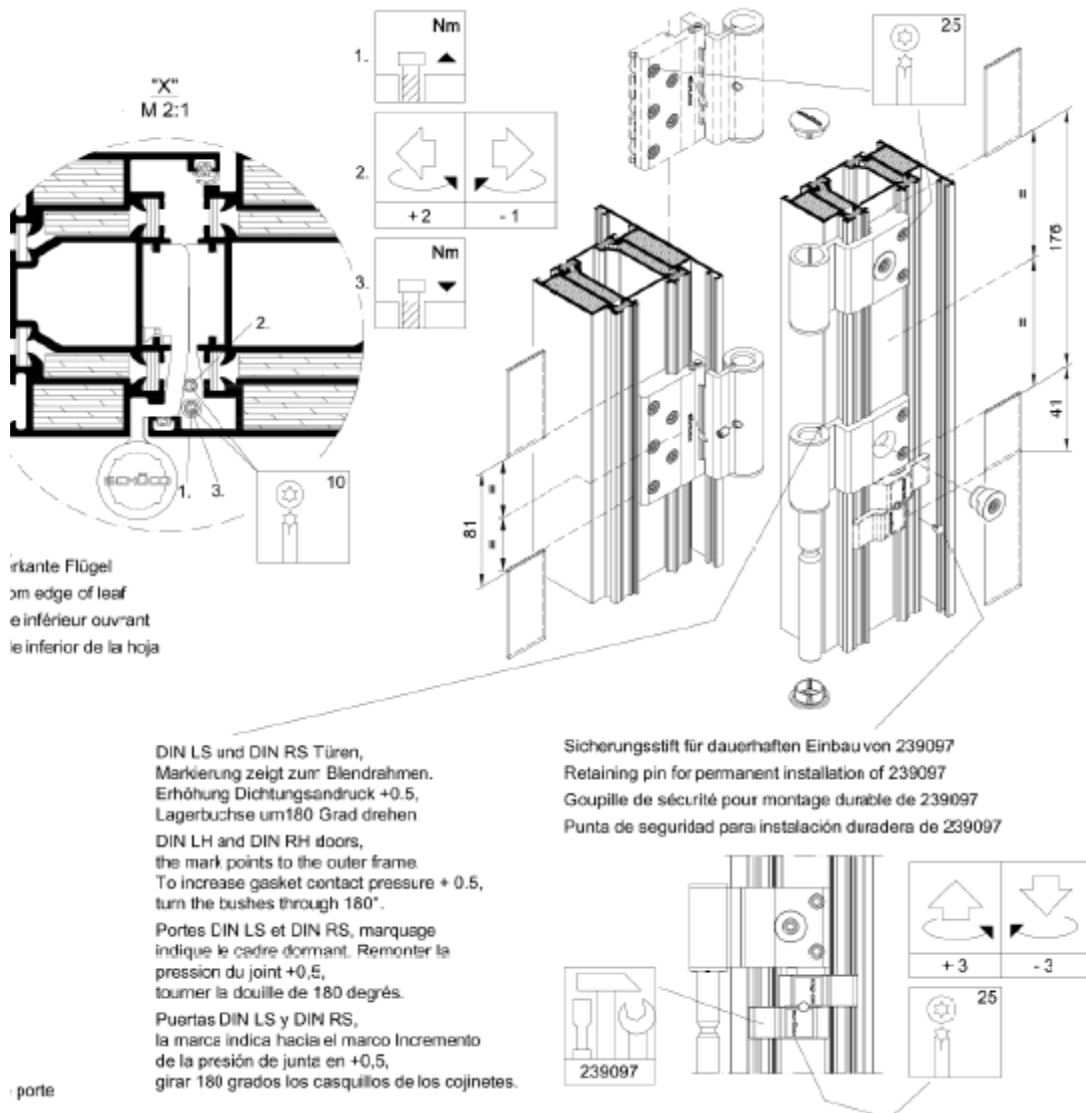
(suite) : Montage des charnières cylindriques en aluminium et en inox en trois parties
